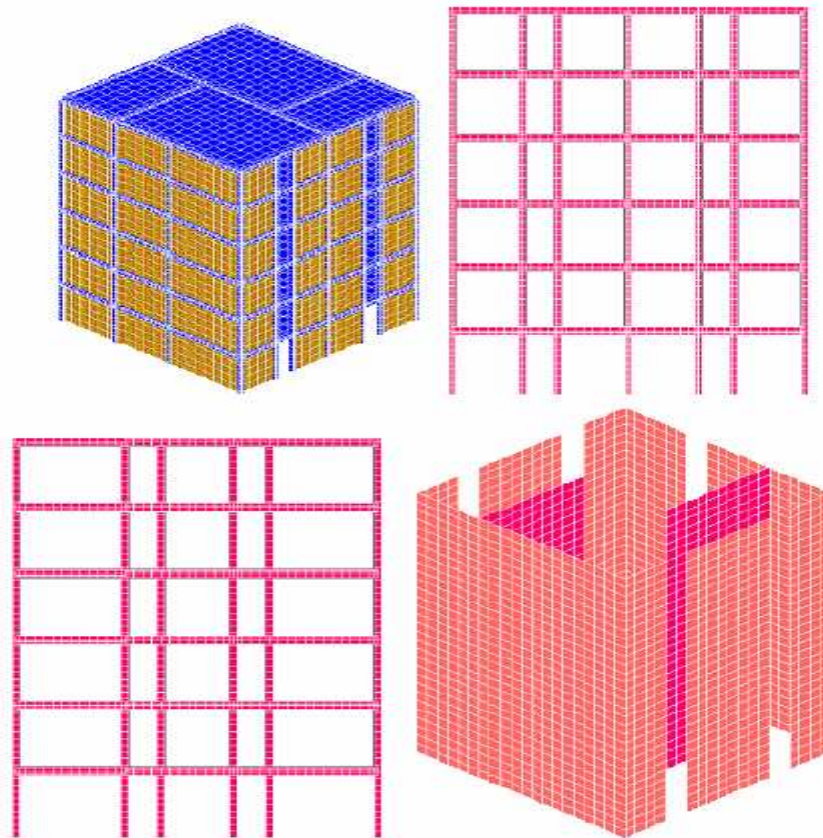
Type 3 - Bâtiment élancé (plus de quatre étages) à façade légère et planchers en béton, à usage principalement de bureaux.
